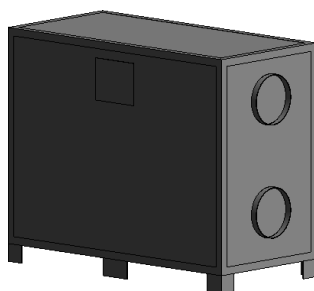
Familia importada a REVIT del recuperador de la ZONA 1 de la planta baja (biblioteca BIM de DAIKIN).
